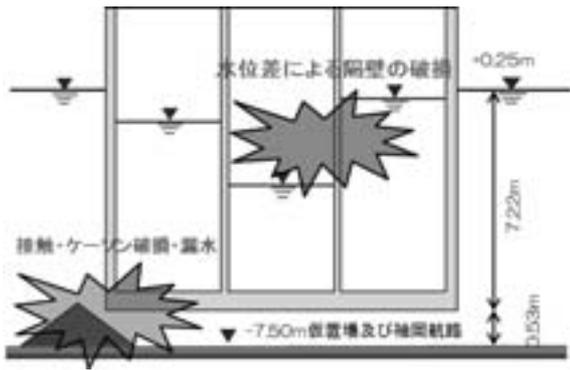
仮置場及び袖岡航標準断面図（浮上・曳航時）
